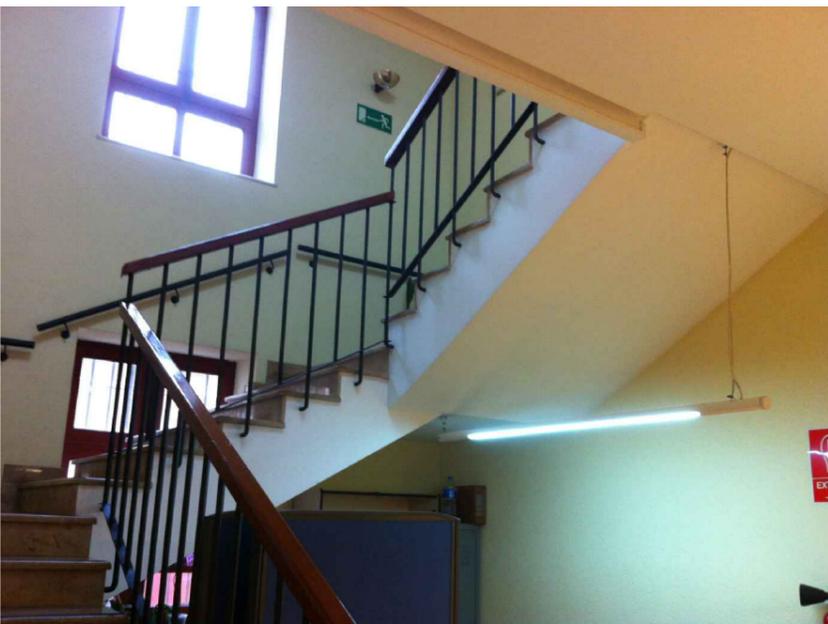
Tramos de la escalera de acceso a la planta primera. 2014. Fuente: elaboración propia.
